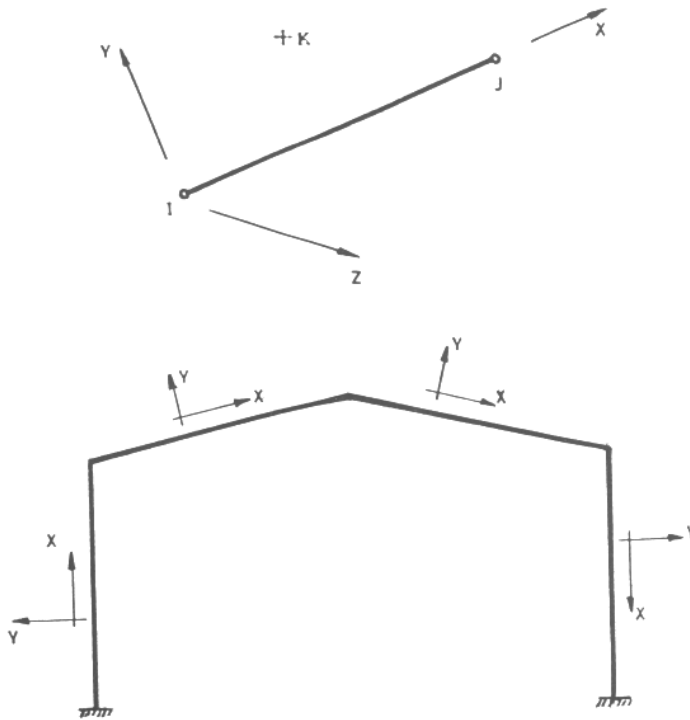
Pórtico. Sistemas de coordenadas locales.
